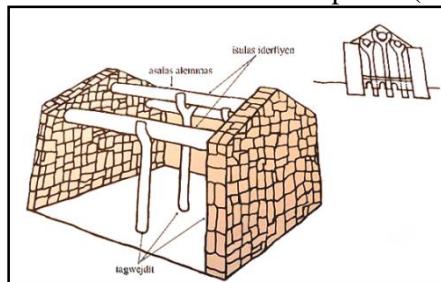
disposition des poutres et des piliers source : Guibbaud.C
